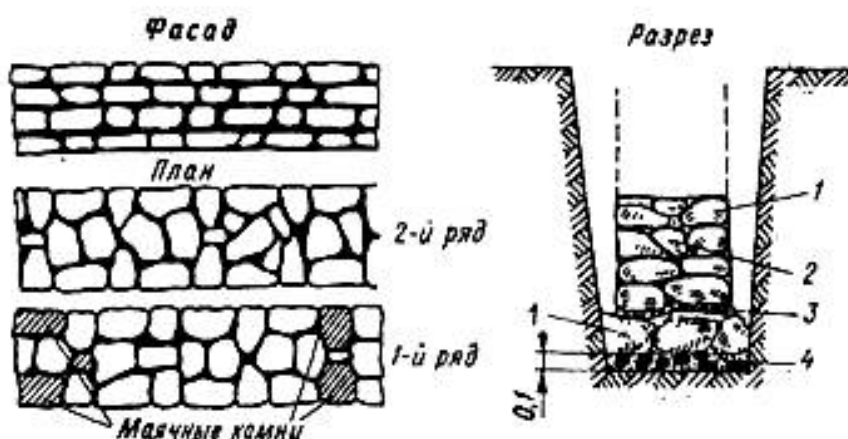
Бутовая кладка фундамента «под лопатку»
